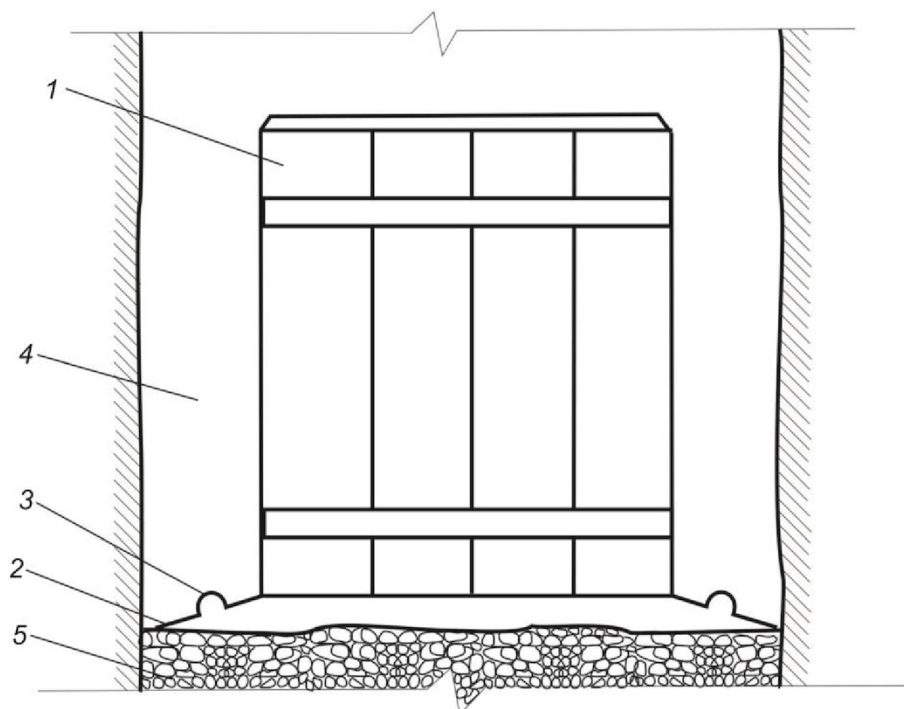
Опалубка для возведения бетонной крепи вертикального ствола:
